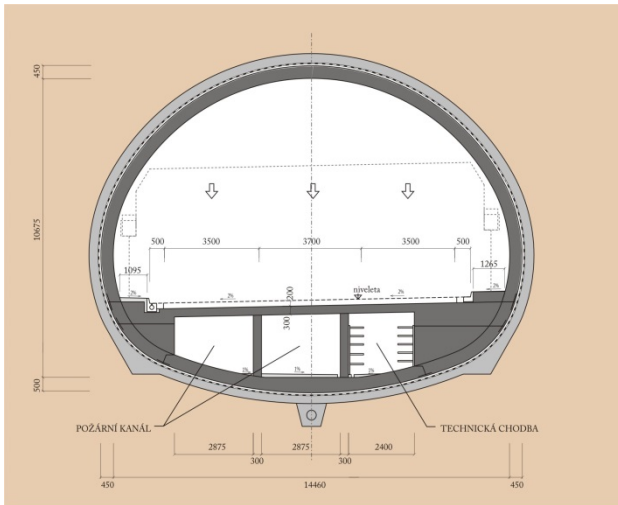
Túnel Mrázovka (ATM) – Sección transversal construida por el método convencional con
